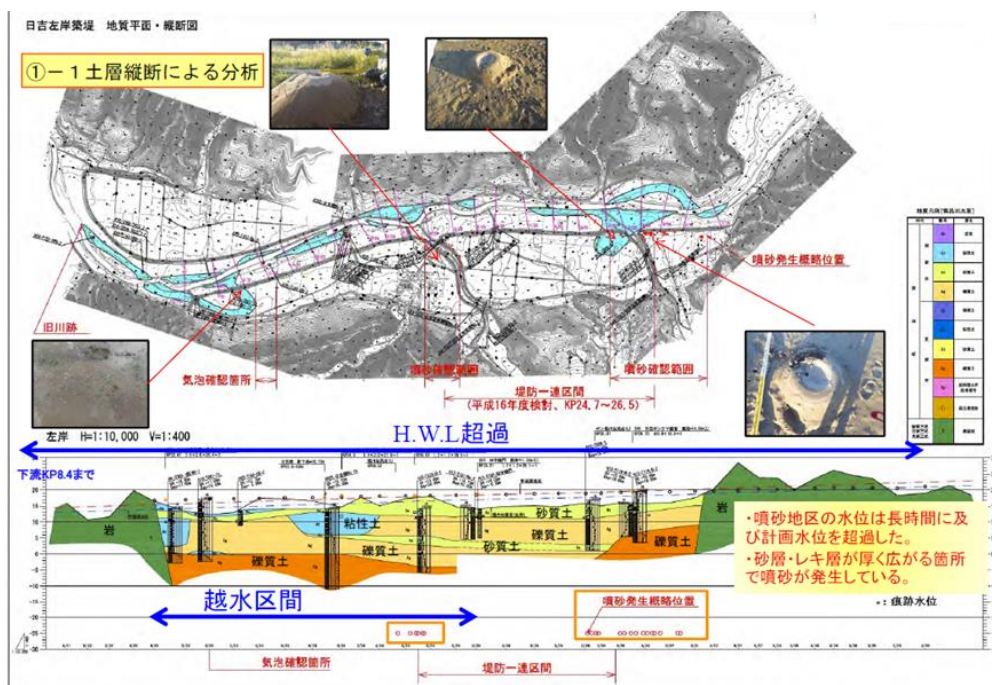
常呂川 H28 洪水噴砂多数発生区間の基礎地盤土層構造 9)
